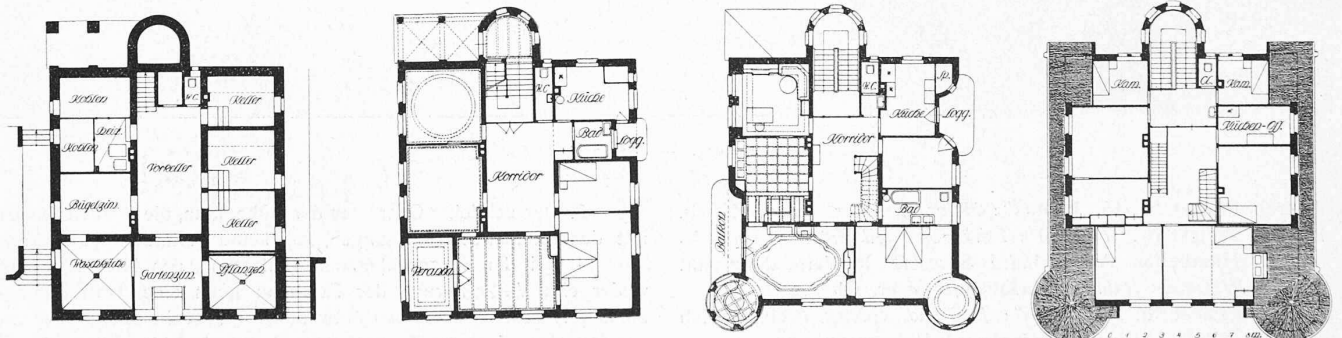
bis 5. Grundrisse vom Untergeschoss, Erdgeschoss, I. Stock und Dachstock. — Masstab 1 : 400.
